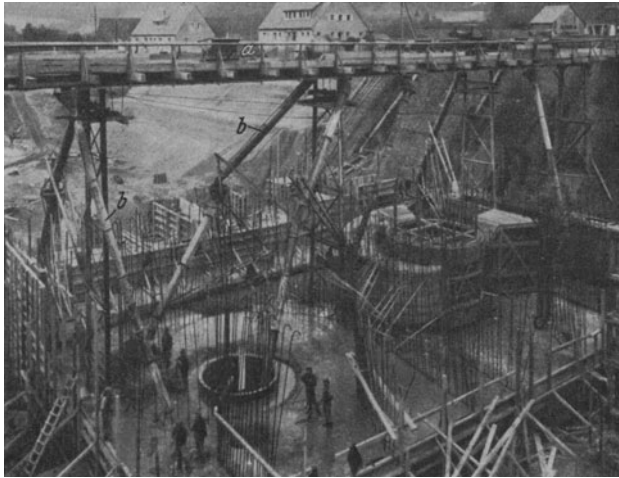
Einrichtung zur Betonierung mit plastischem Beton beim Krafthaus Mixnitz an der Mur. (Steweag, Graz.)
